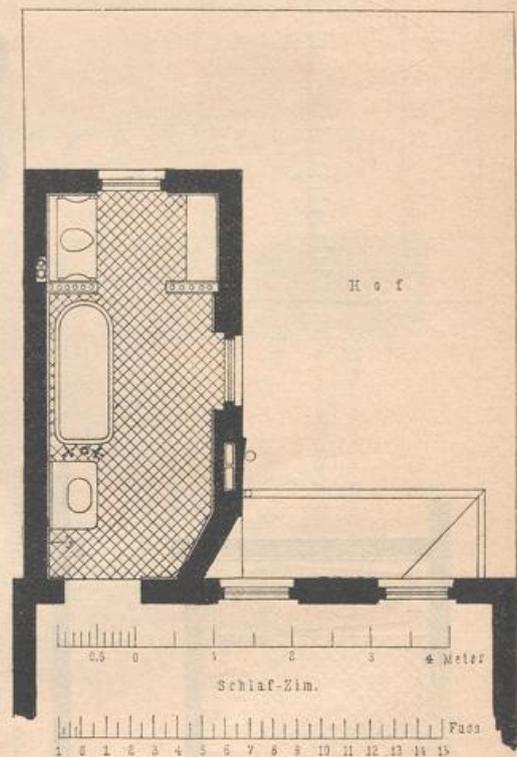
stellt im Grundriss die getrennte Anordnung eines Badezimmers und
